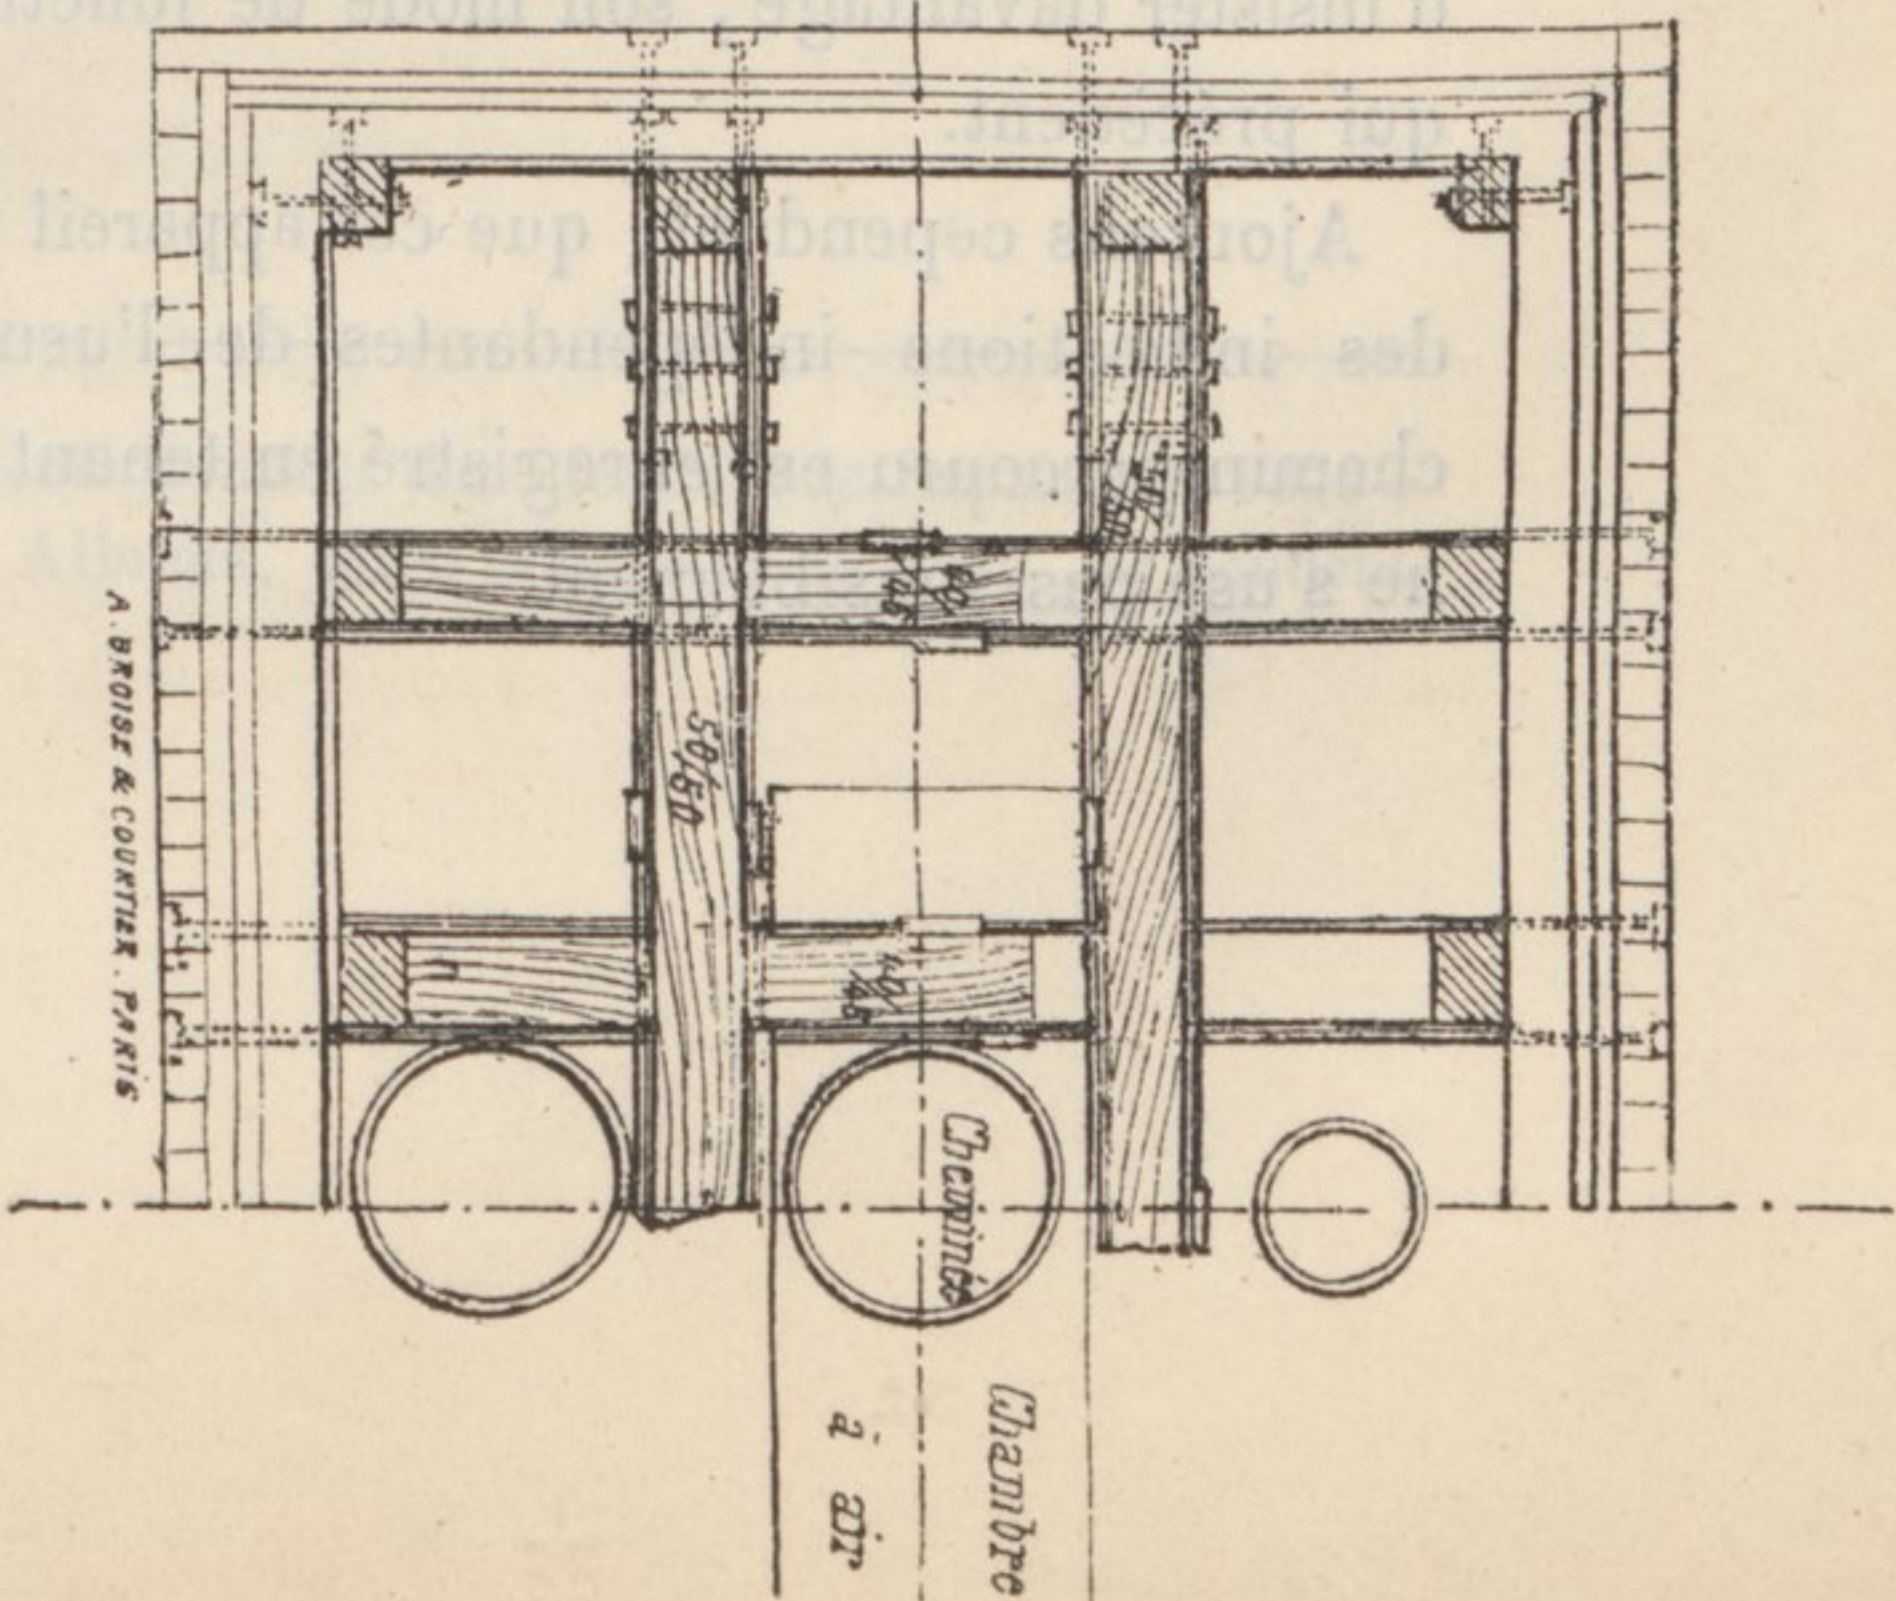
à 167. — DETAILS DU CAISSON (CÔTÉ DE NEW-YORK).
